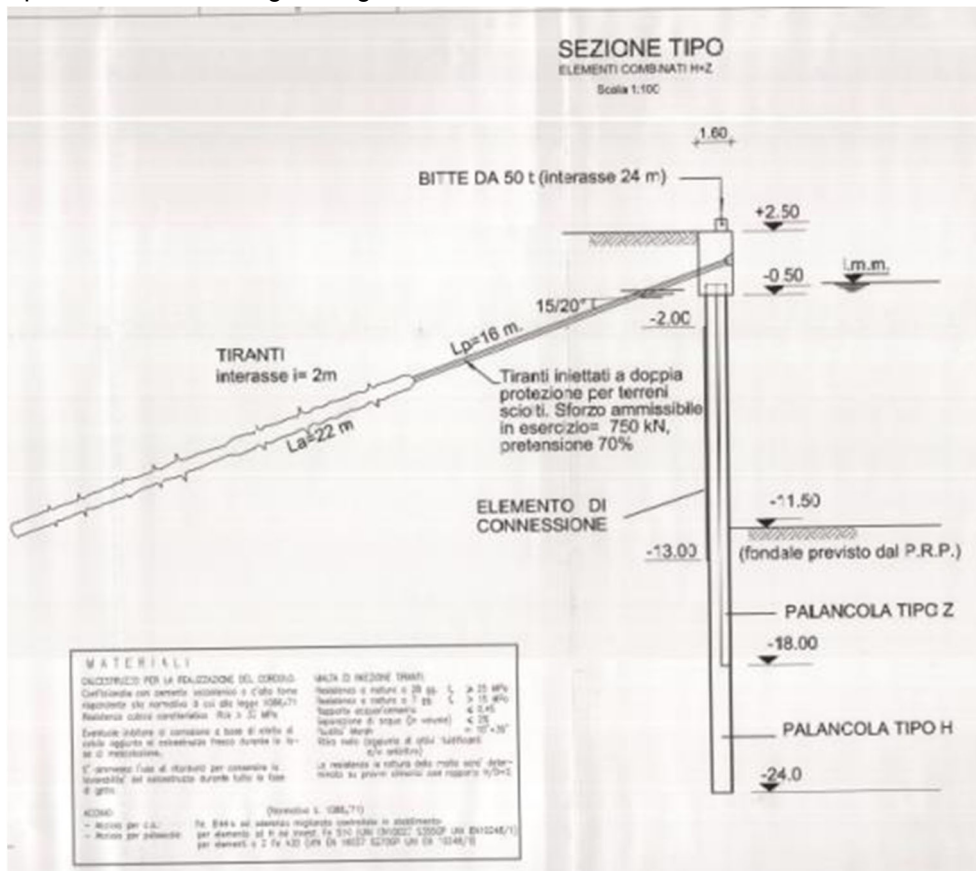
Sezione tipo della banchina “D” nella situazione attuale
